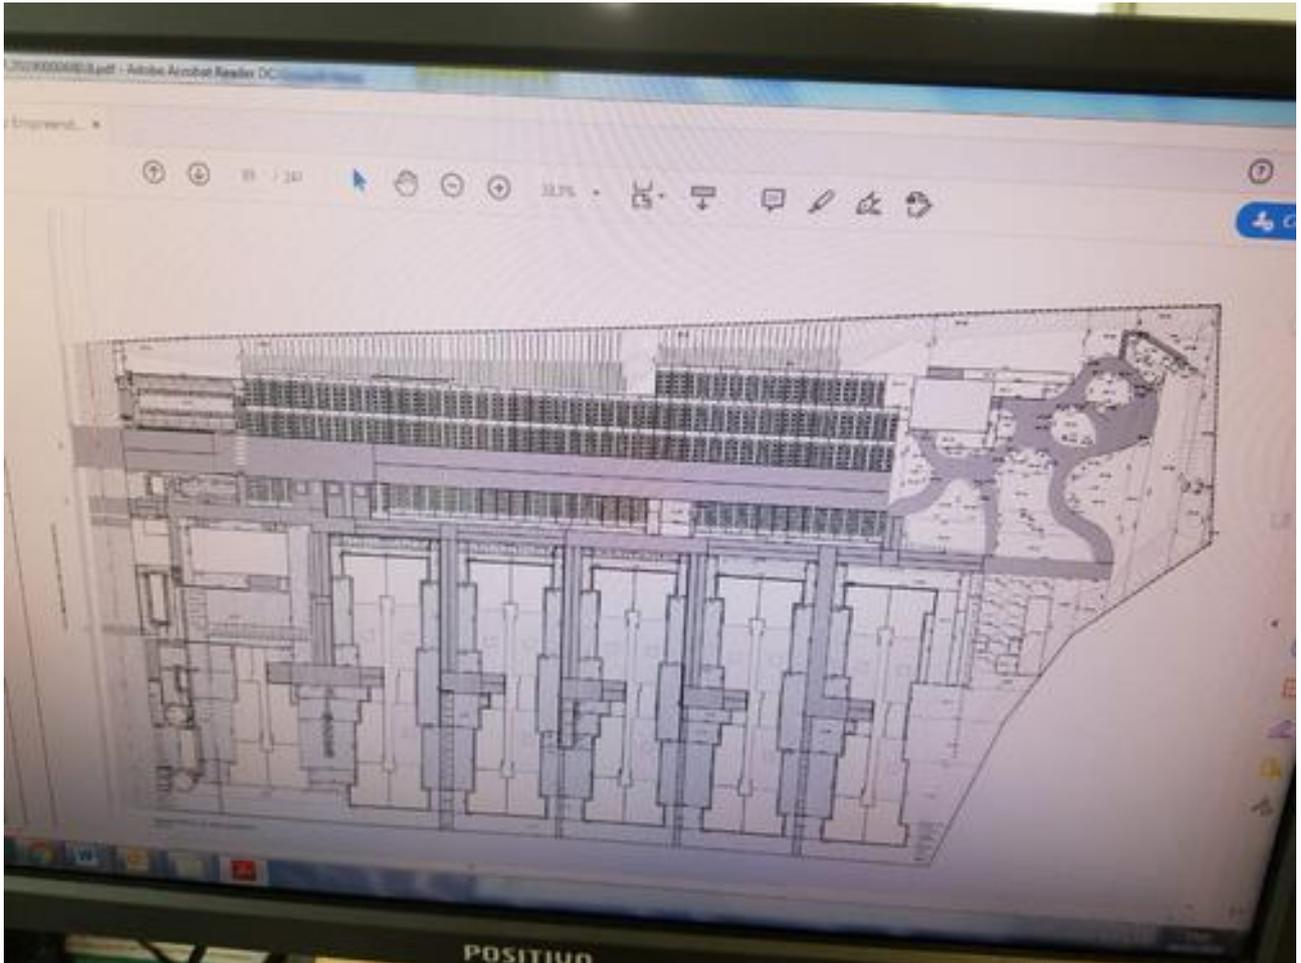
e 35. Planta e corte do empreendimento no Lote 1.
